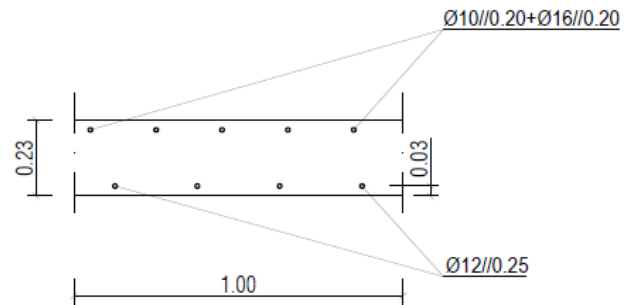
Secção transversal da Zona de Apoio para direção Y
